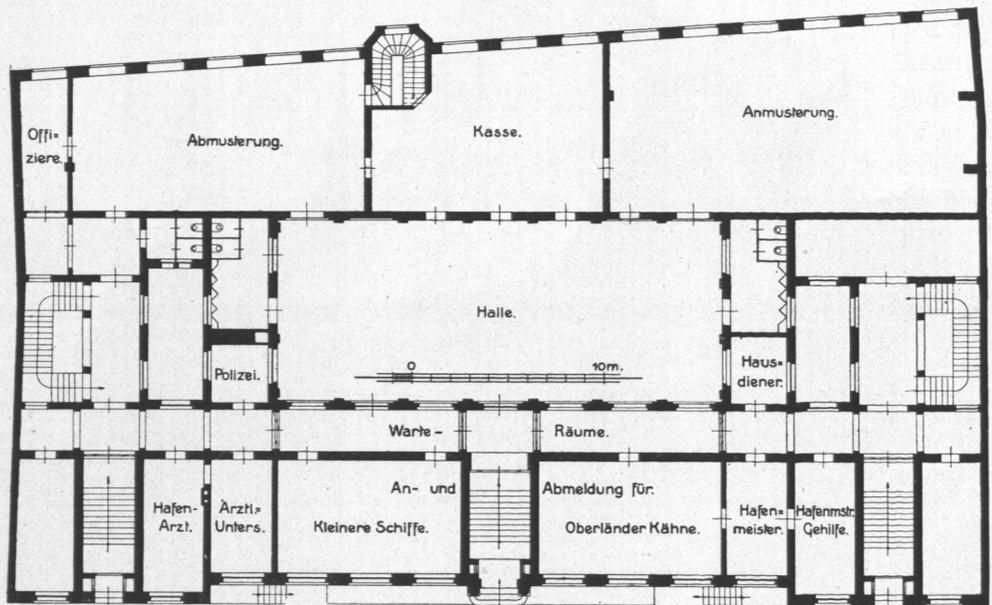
Marinegebäude, Grundriß, Erdgeschoß.
